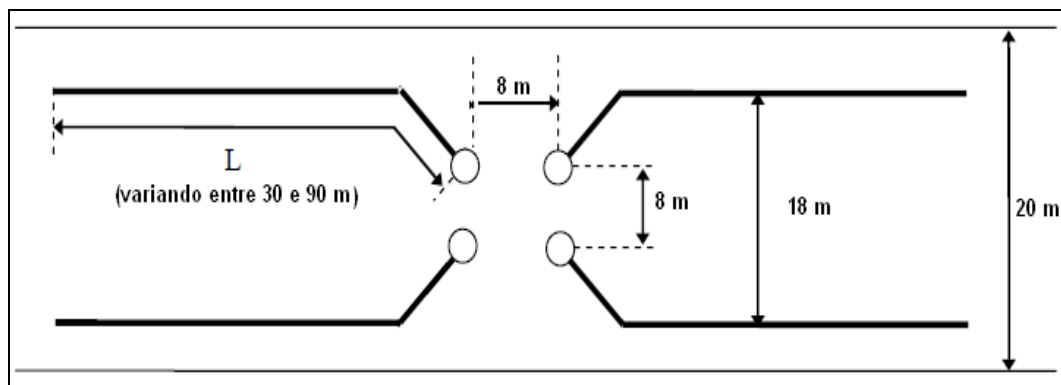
Configuração do aterramento no pé da estrutura metálica, vista em planta.
